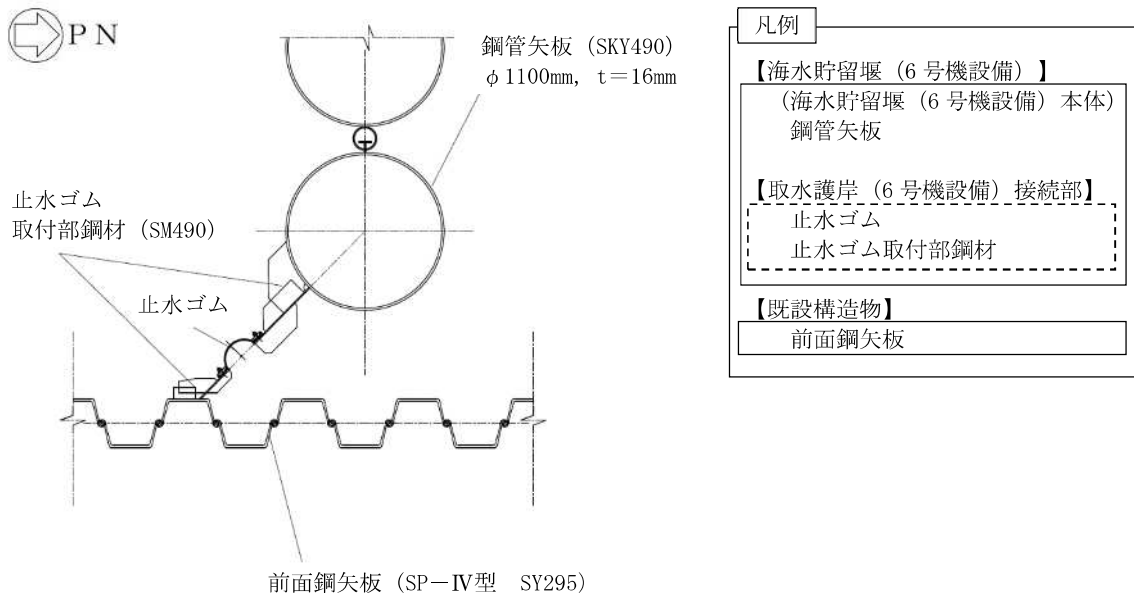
(2) 取水護岸（6号機設備）の平面図（A部拡大）
